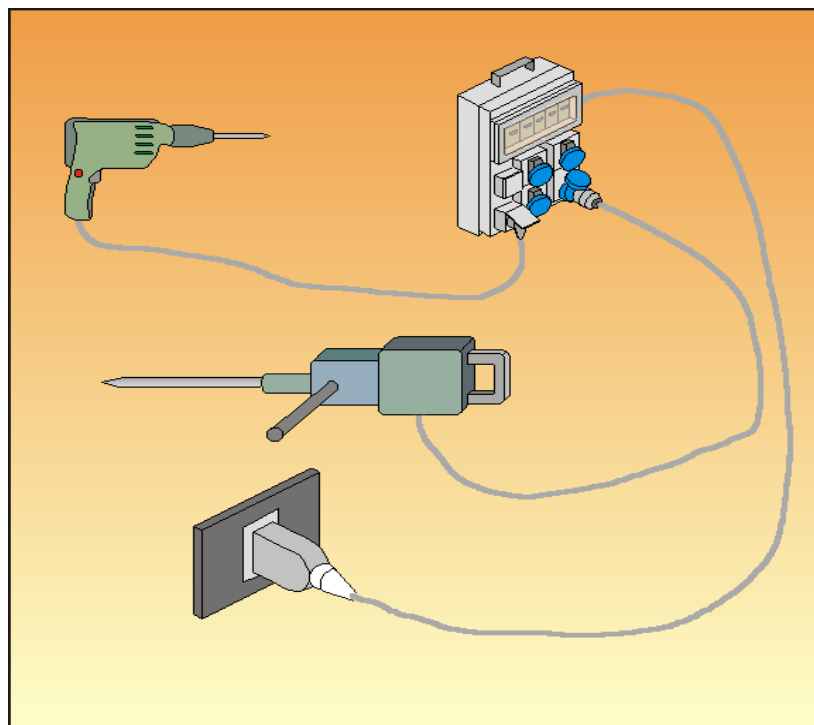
Quadretto alimentato direttamente dall'impianto esistente
